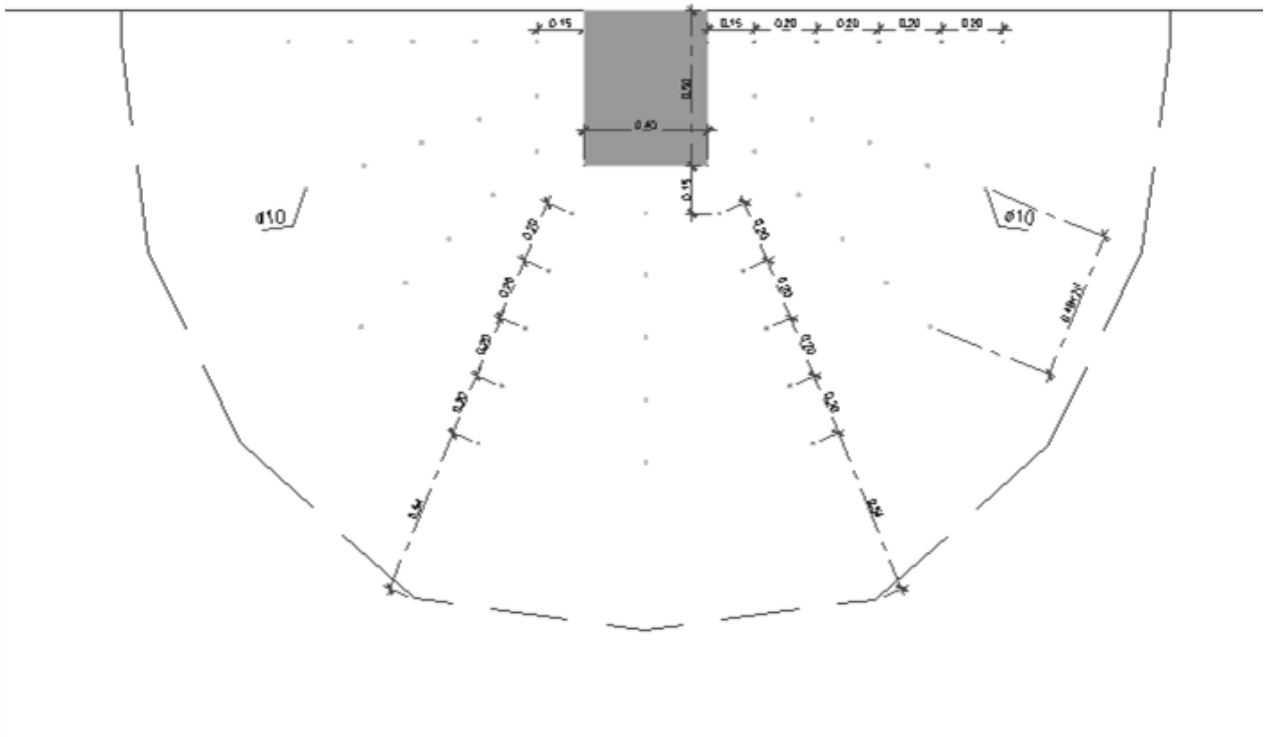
Planta da armadura de punçamento do primeiro caso em análise (pilar de bordo P4).
